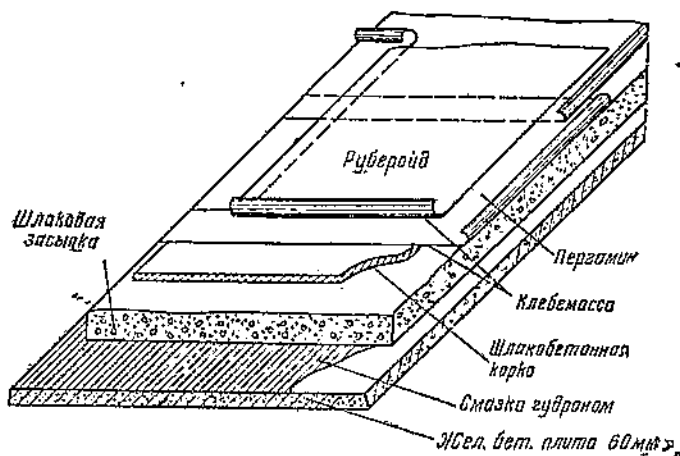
Конструкция рулонной кровли при утепленном железобетонном перекрытии.
